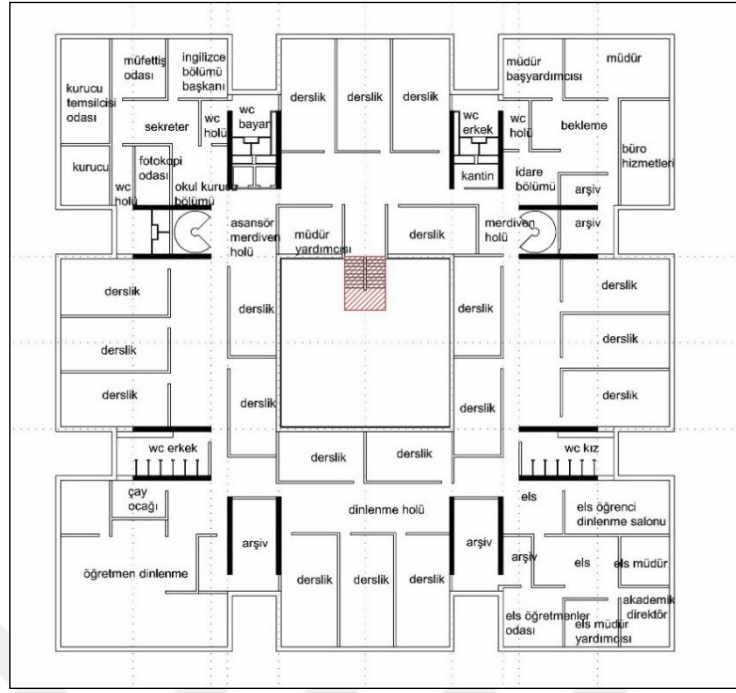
Ara kat planı (-5.90, -7.46 kotu planı) (ZBA, Rölöve projesi üzerinden üretilmiştir).
